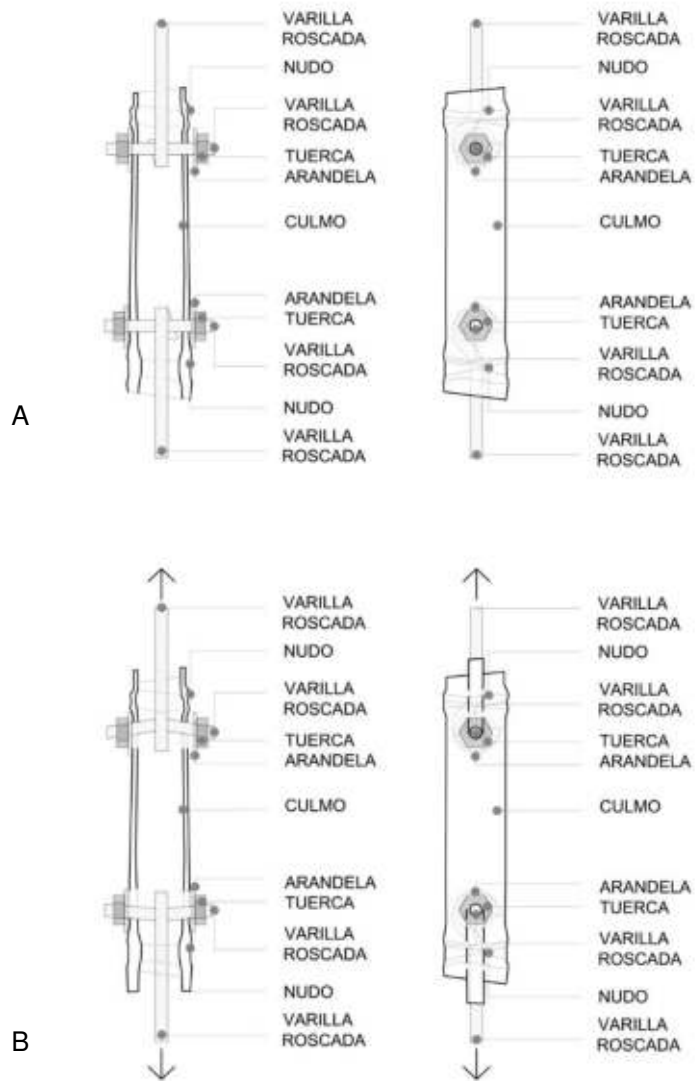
Detalle constructivo de dispositivo 4. a) Situación inicial de dispositivo 4, b) Situación final con varilla deformada luego de esfuerzo de tracción de 337kg.
